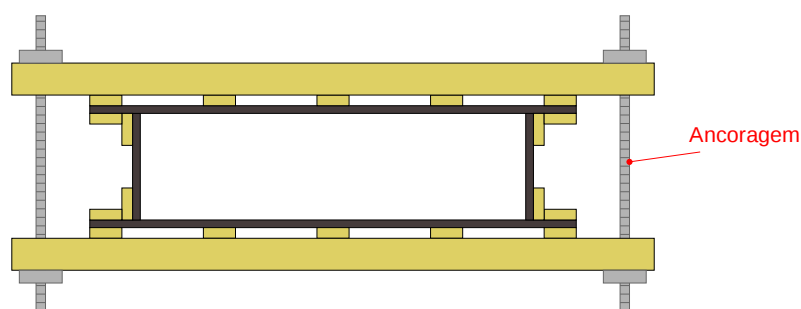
Espaçamento máximo dos sarrafos verticais dos painéis do pilar P1
